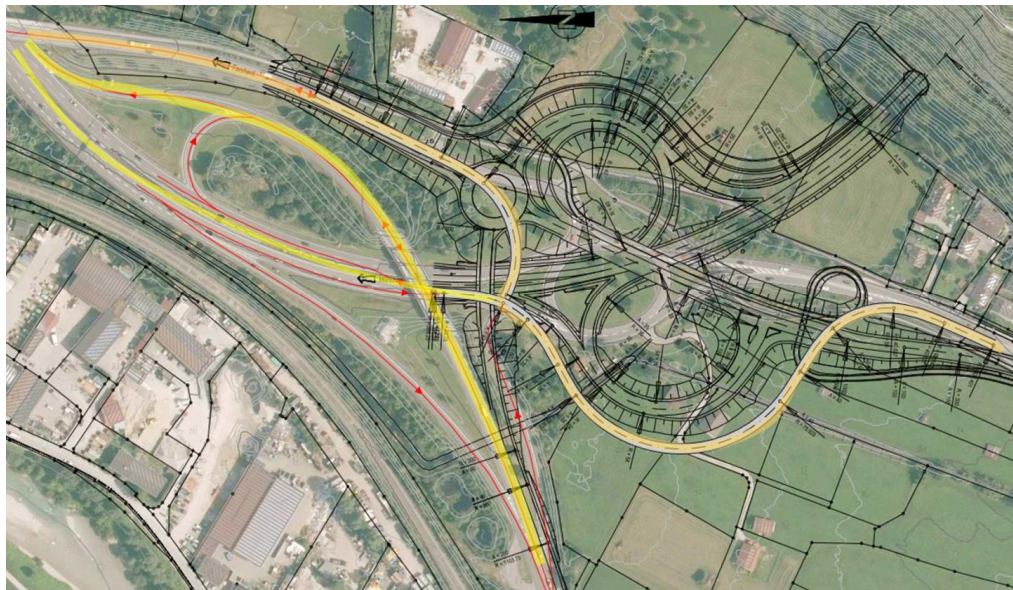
Verkehrsführung während der Bauzeit - Anschlussstelle Nord; Darstellung nachrichtlich
